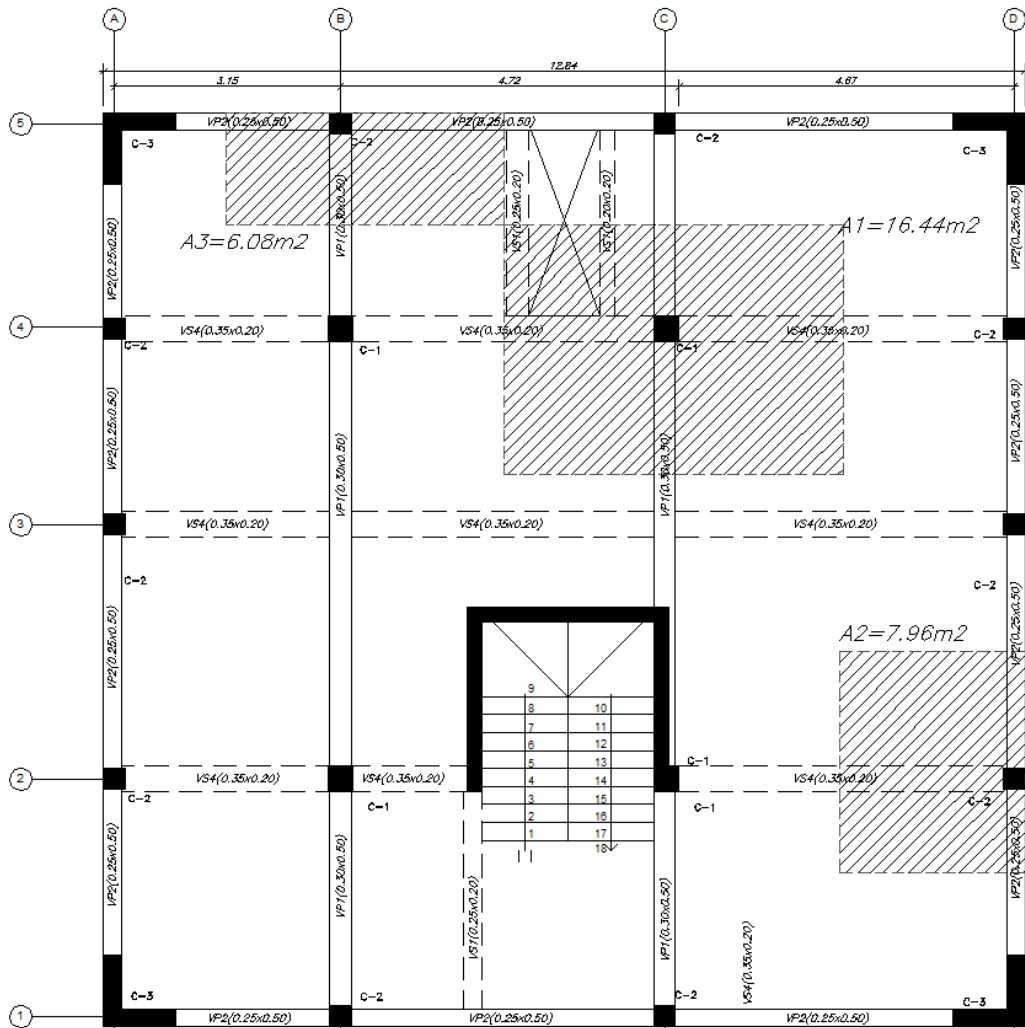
Áreas tributarias para pre dimensionamiento de las columnas y zapatas
